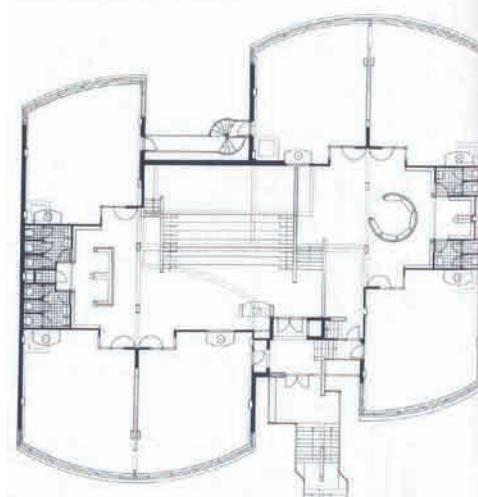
Plan wat vloeiente ruimtes en skakeling tussen klaskamers toon
